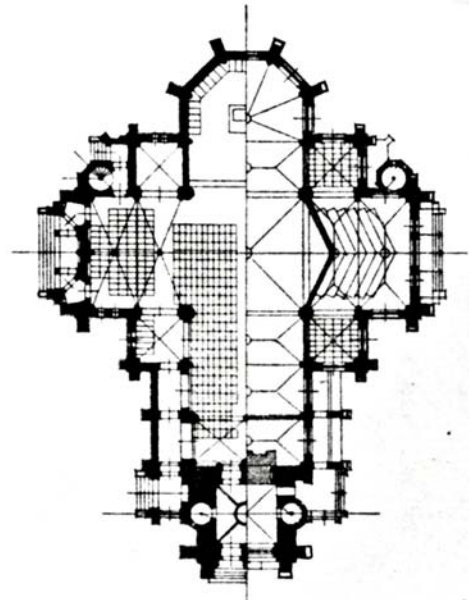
Grundriss, Erd- und Emporengeschoss
